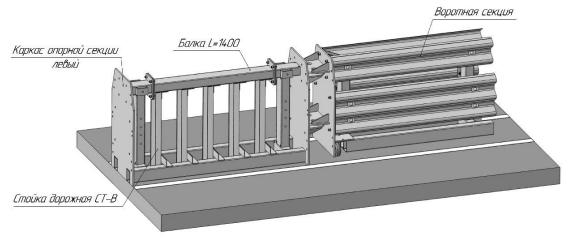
Схема крепления левого каркаса на место монтажа
